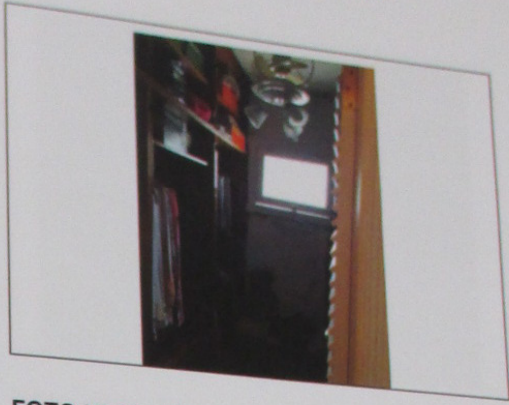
Vista do Banheiro da Suíte 2.
